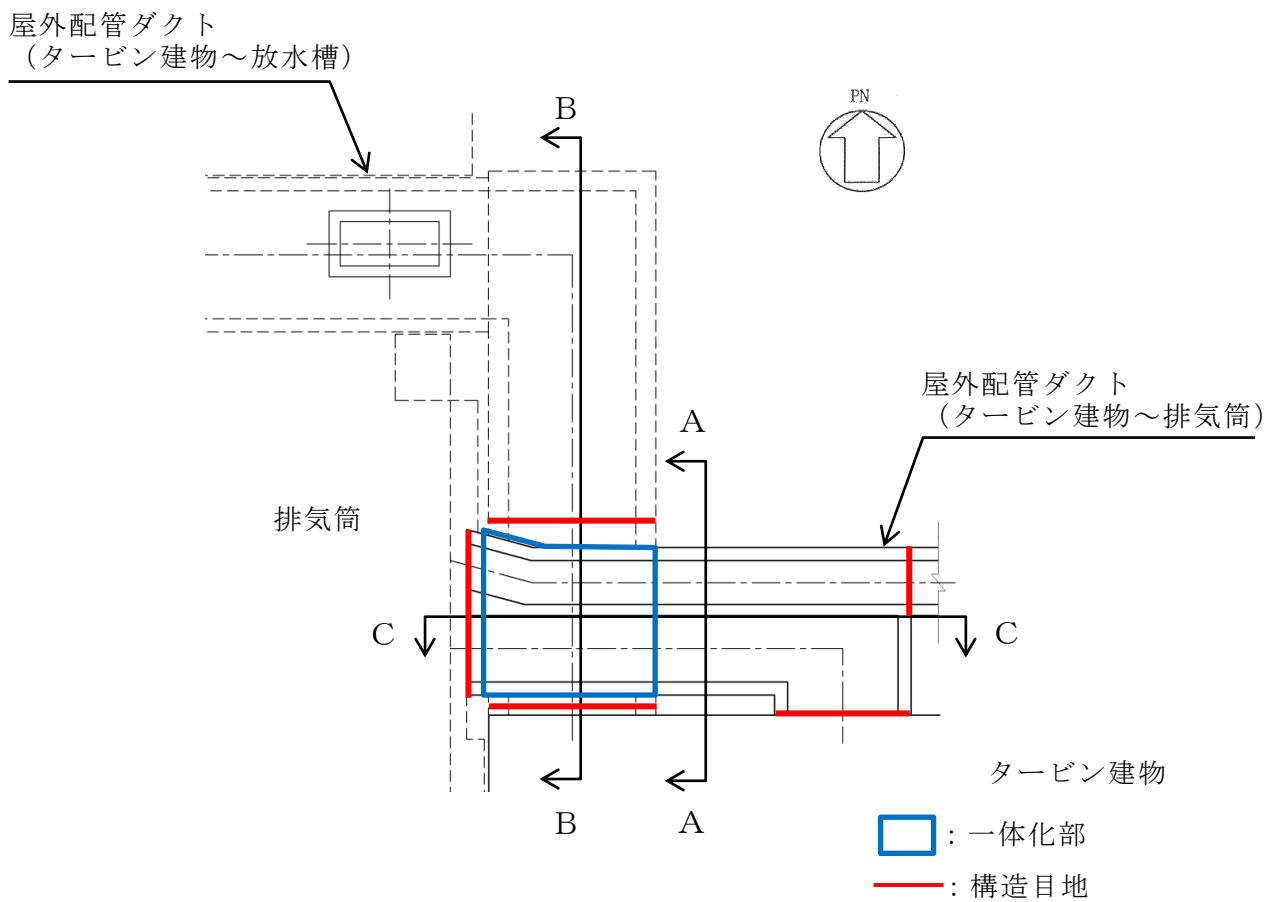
屋外配管ダクト（タービン建物～排気筒） 平面図
